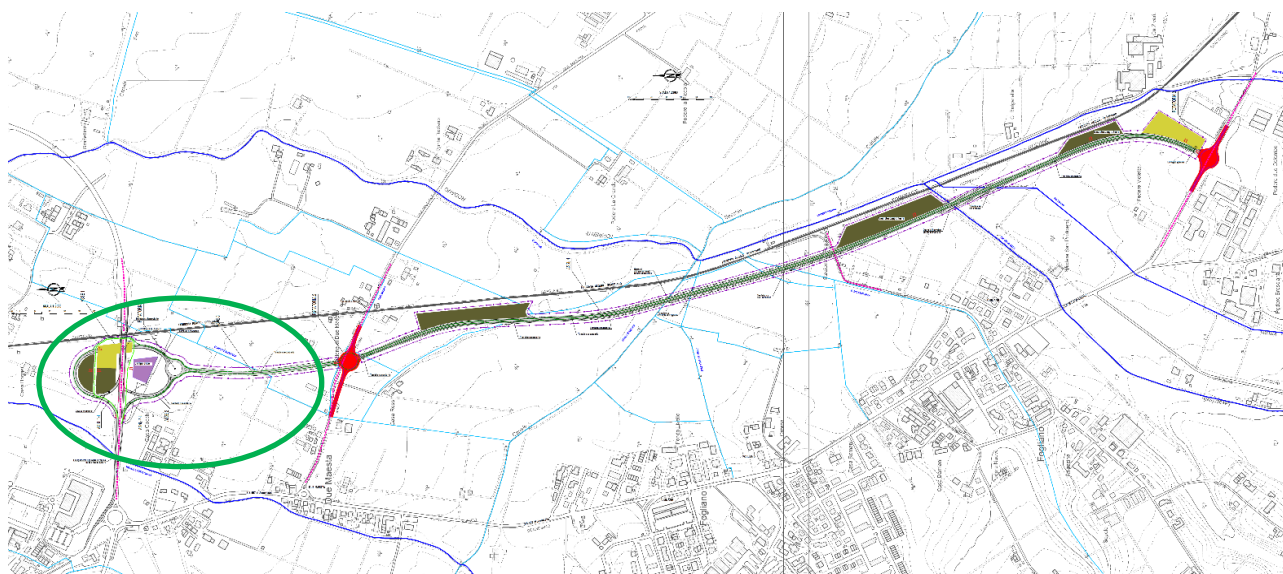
localizzazione lotto di intervento e aree di cantiere
